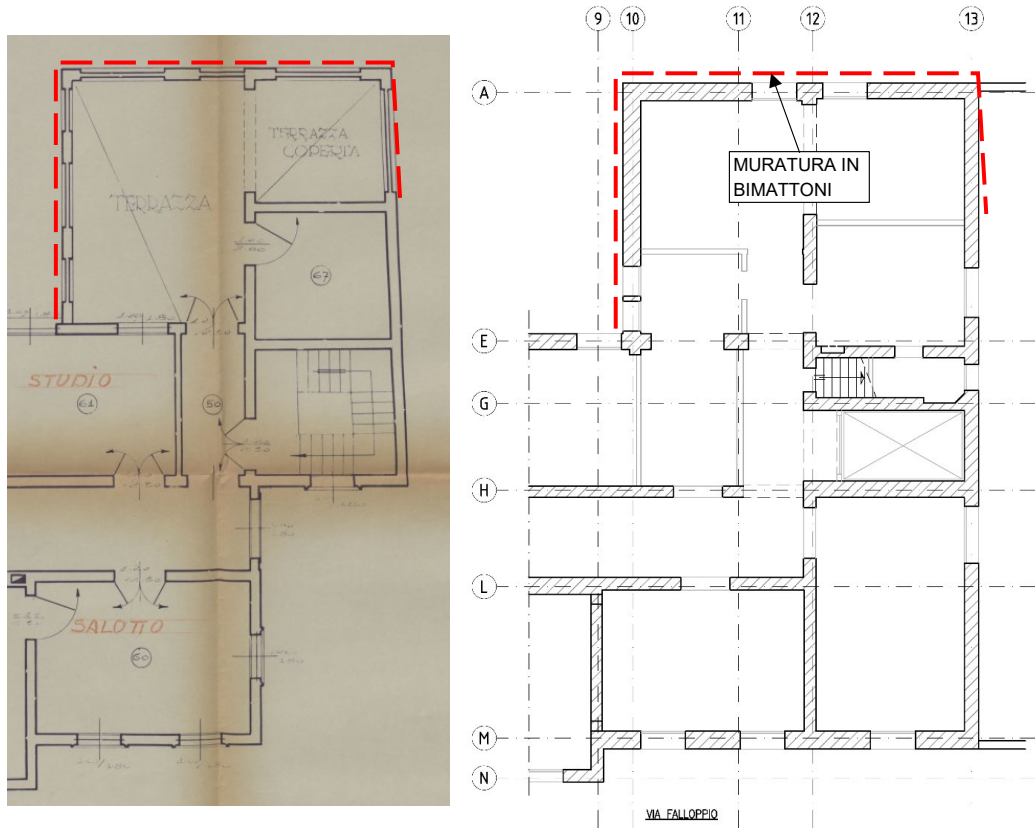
Stralci Pianta Secondo Piano – Confronto elaborato di progetto del 1932 – stato attuale
